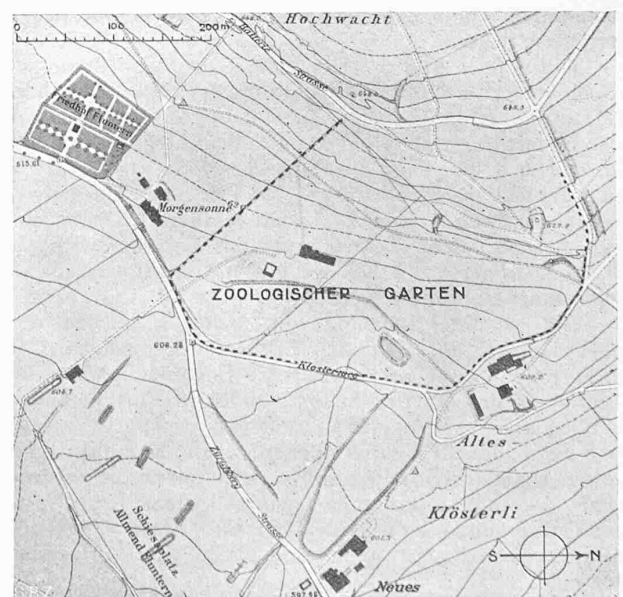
Situationsplan. — Masstab 1:7000, mit 4 m Höhenkurven.
